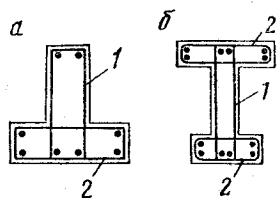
Армирование элементов, испытывающих изгиб с кручением
